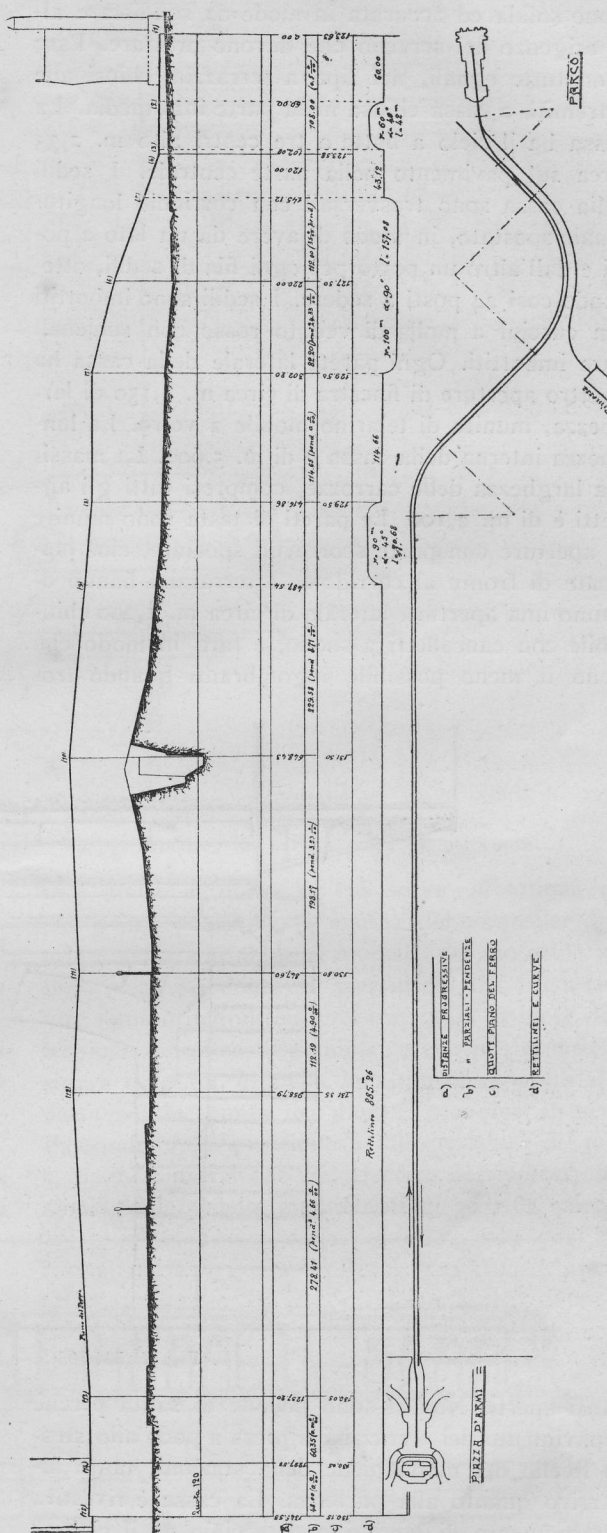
(302-303). — Profilo longitudinale e planimetria.
